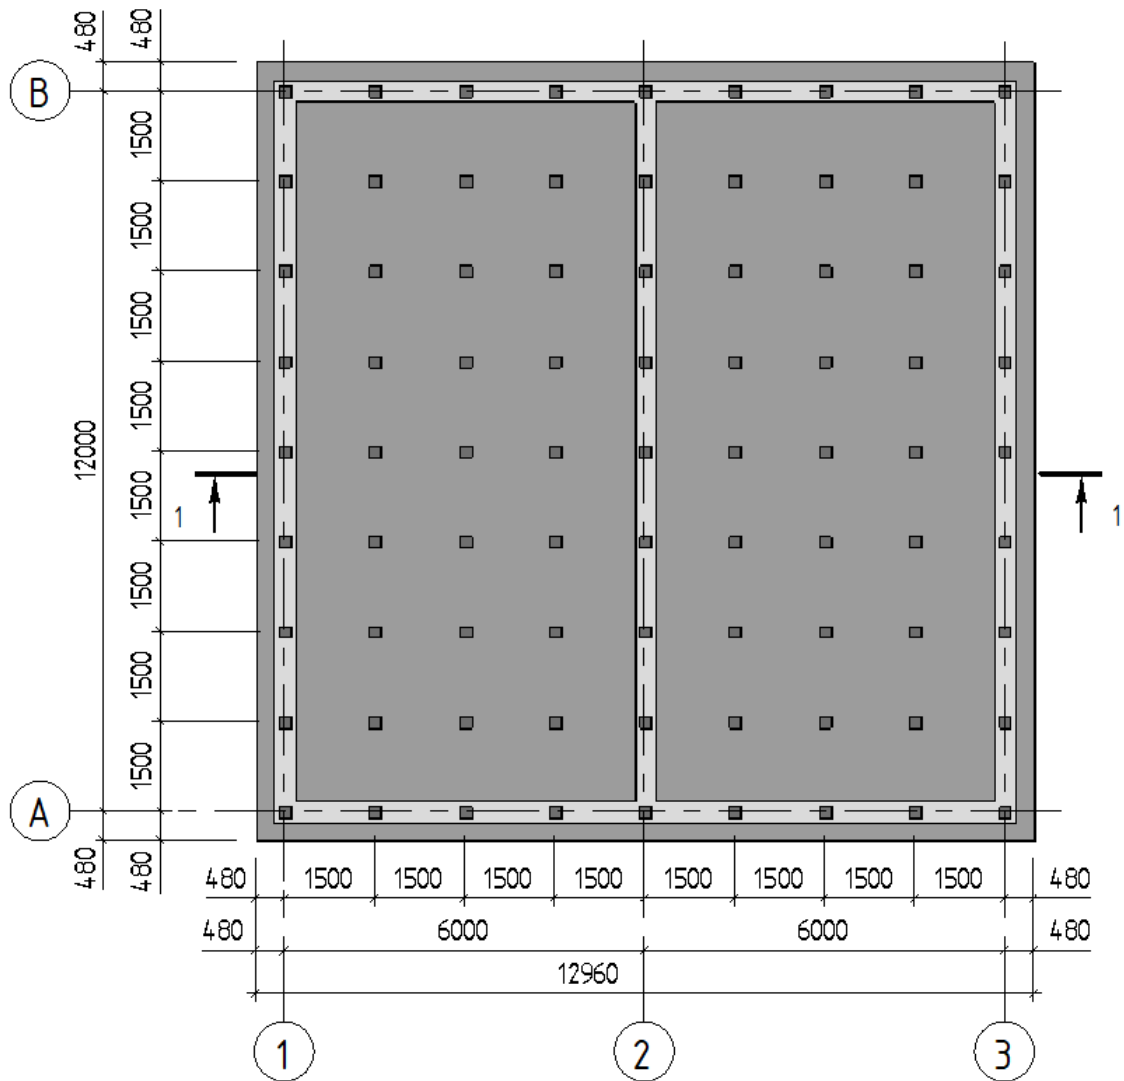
Фундаментная плита с габаритными размерами 12 x 12 м
